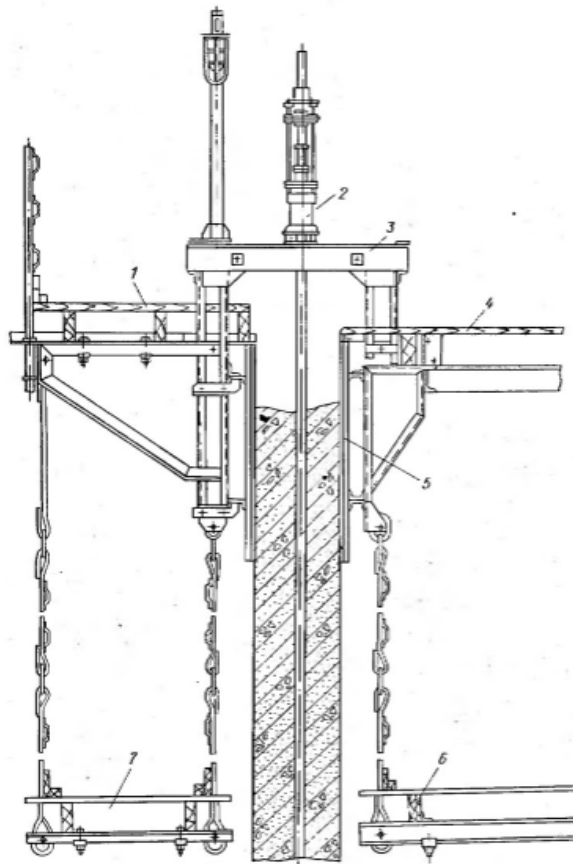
Скользящая опалубка: 1 – козырек; 2 – домкрат; 3 – домкратная рама; 4 – рабочий пол; 5 – щиты опалубки; 6, 7 – подвесные подмости
